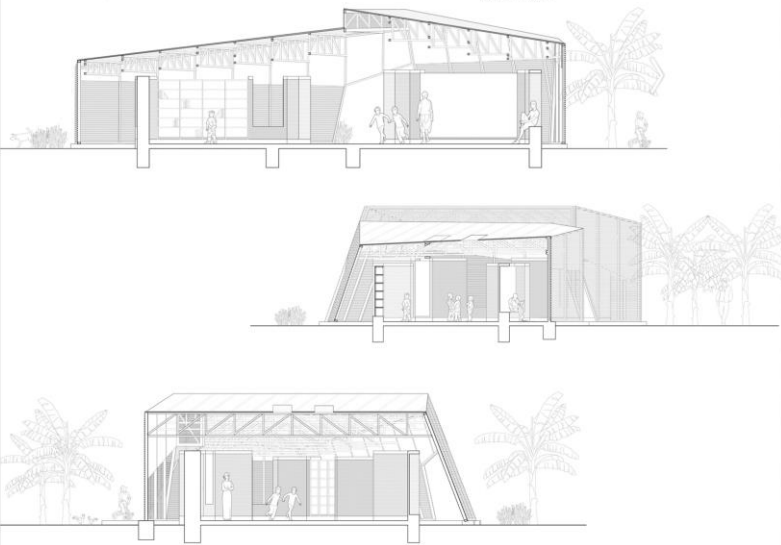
Vista de fachada frontal de proyecto. Fuente: ArchDaily
